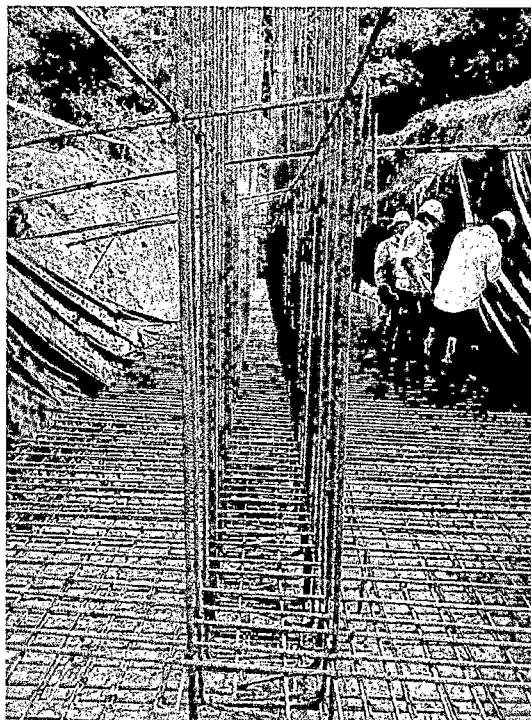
COLOCACION ACERO LOSA DE CIMENTACION DE MURO
